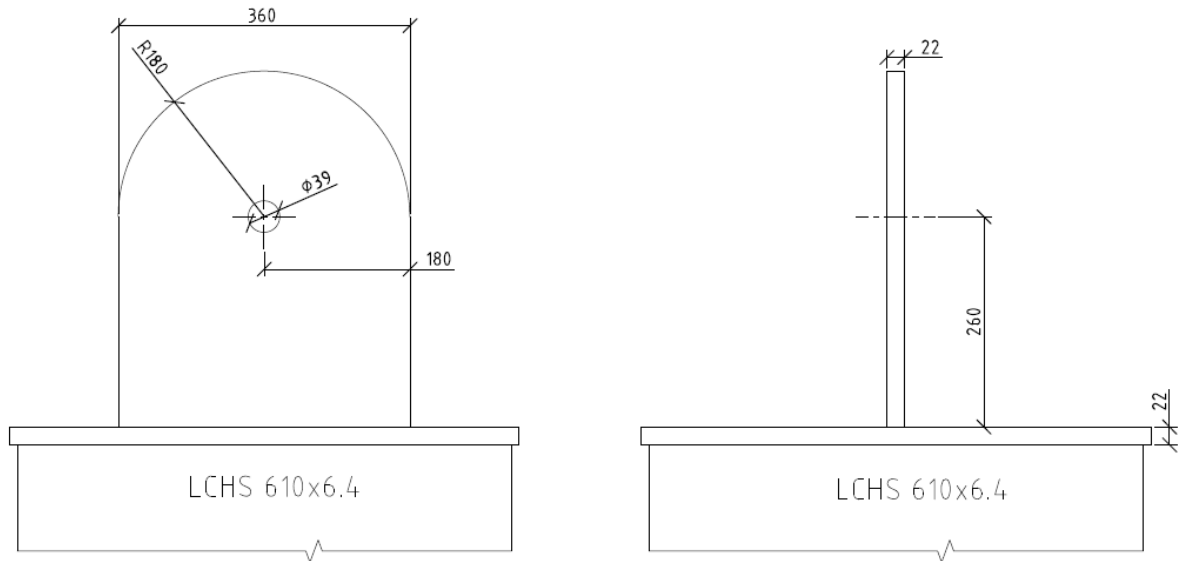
Geometria da ligação da diagonal do contraventamento às pernas do pórtico
